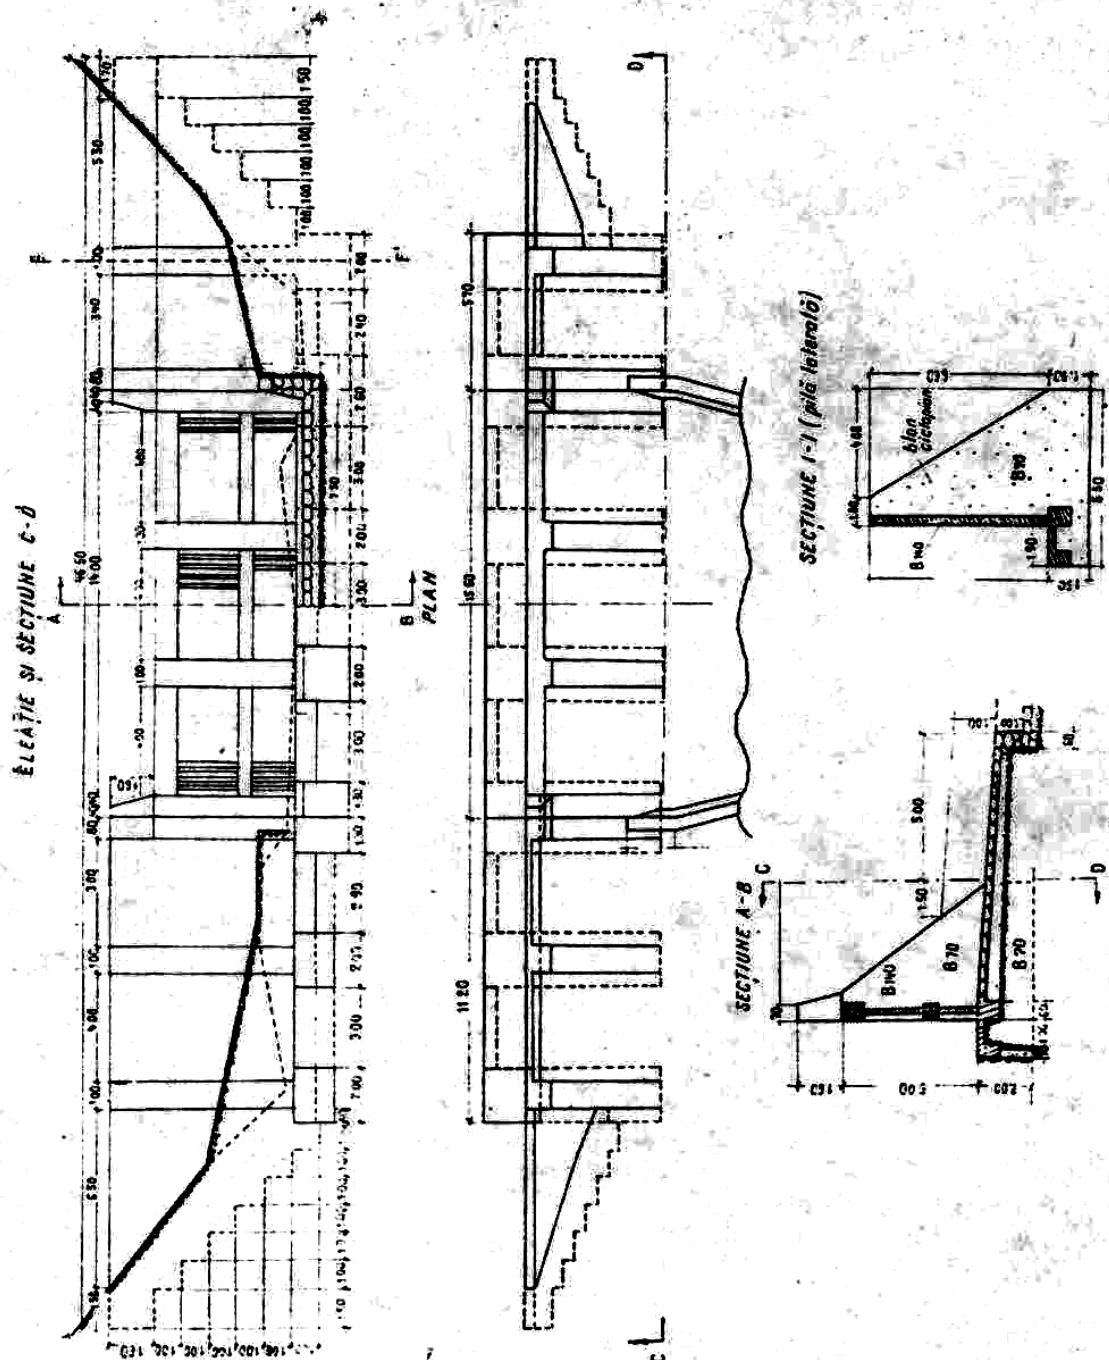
Baraj filtrant din grilă de beton armat pe contraforți
